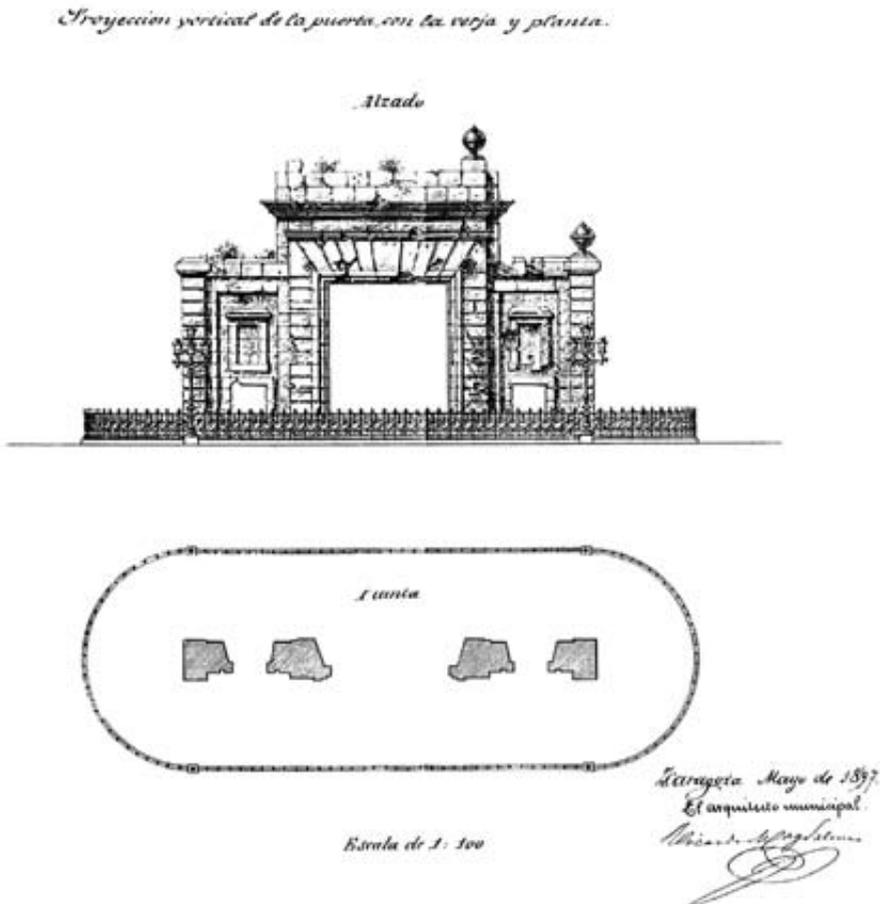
Planta y alzado principal de la Puerta del Carmen, dibujados por Ricardo Magdalena (1897). Los planos originales no se conservan.
